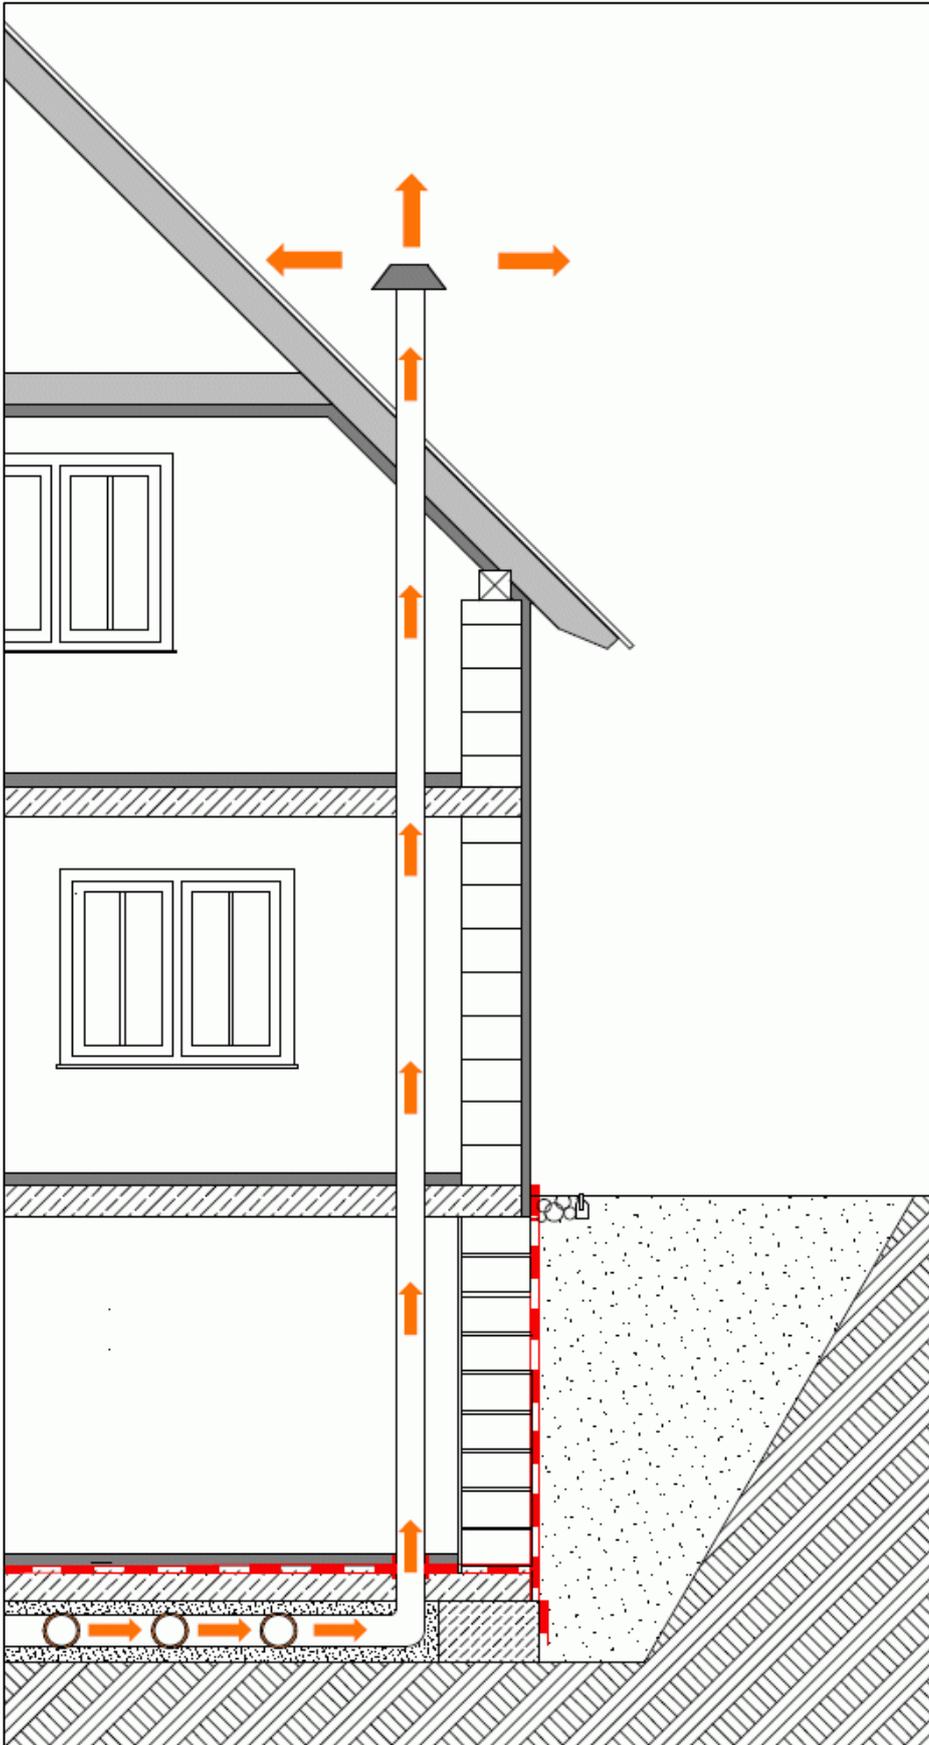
Vertikalschnitt Radondrainage, Neubau
